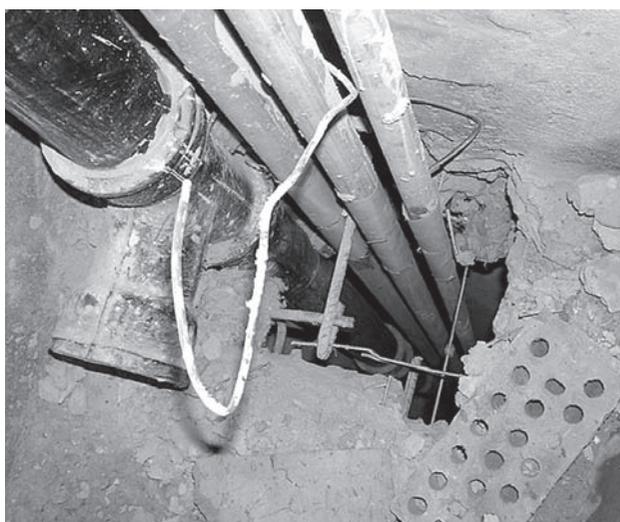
Фрагмент одной из поврежденных плит на объекте.
